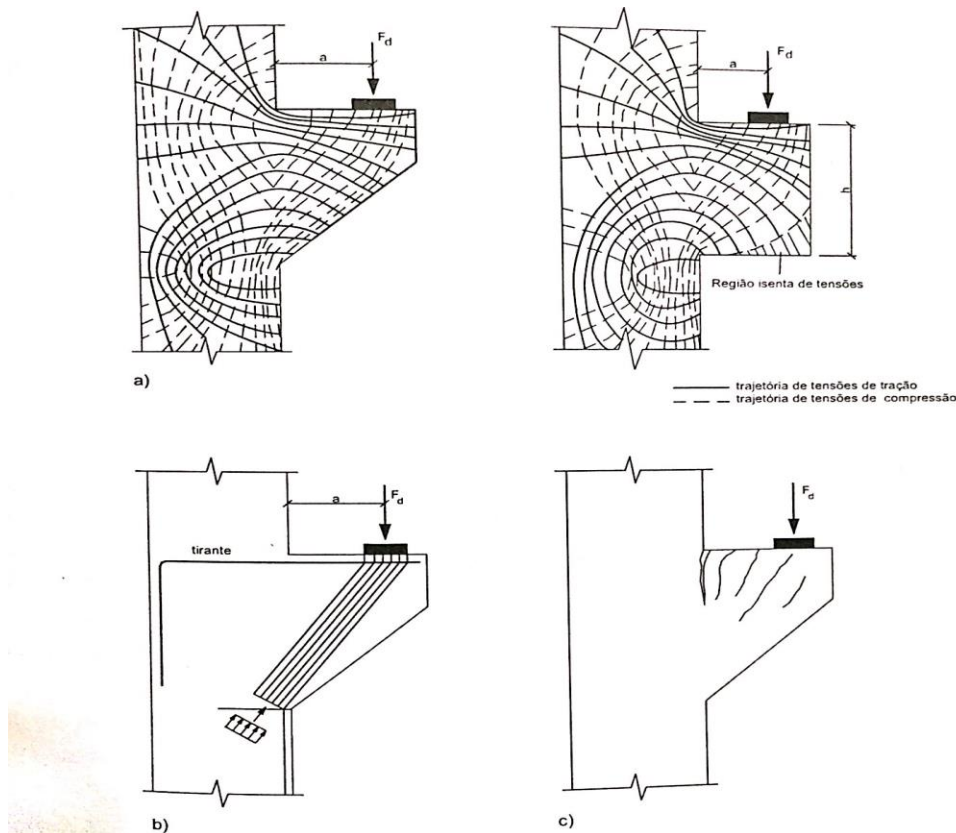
Trajetória de tensões, modelo resistente e configuração fissurada dos consolos.
